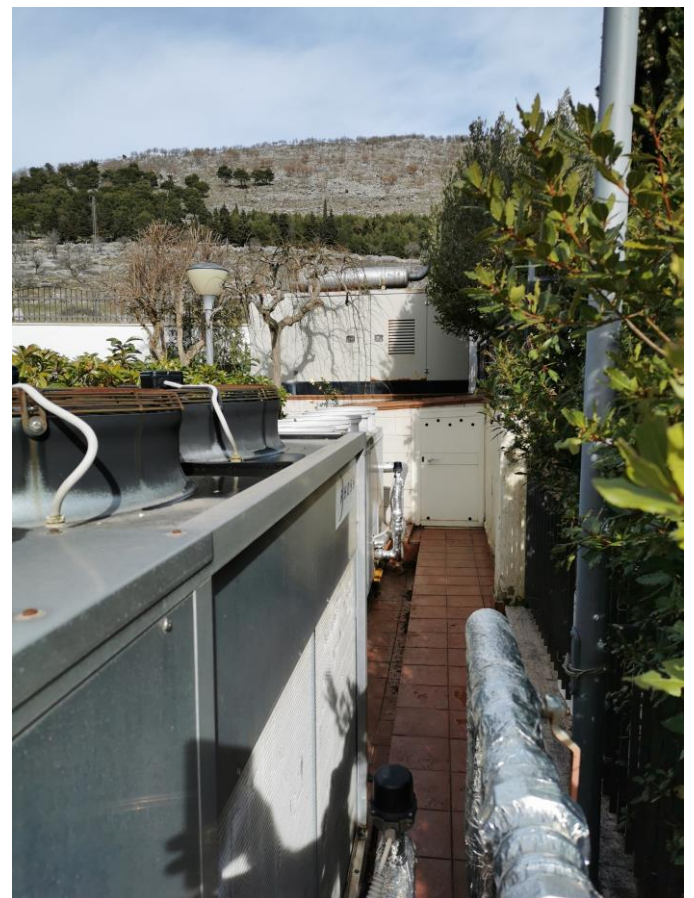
zona impianti – prospetto retrostante ingresso da SS272
